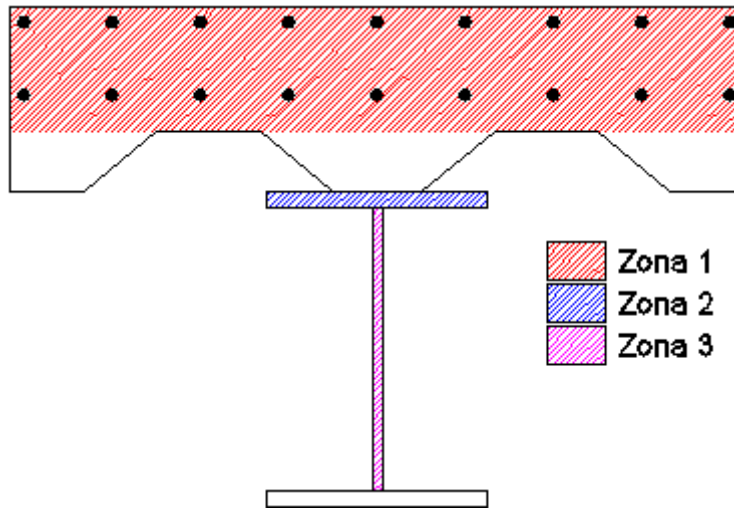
Localizações do eixo neutro para secções sem perfil metálico parcialmente envolvido em betão (M-).
